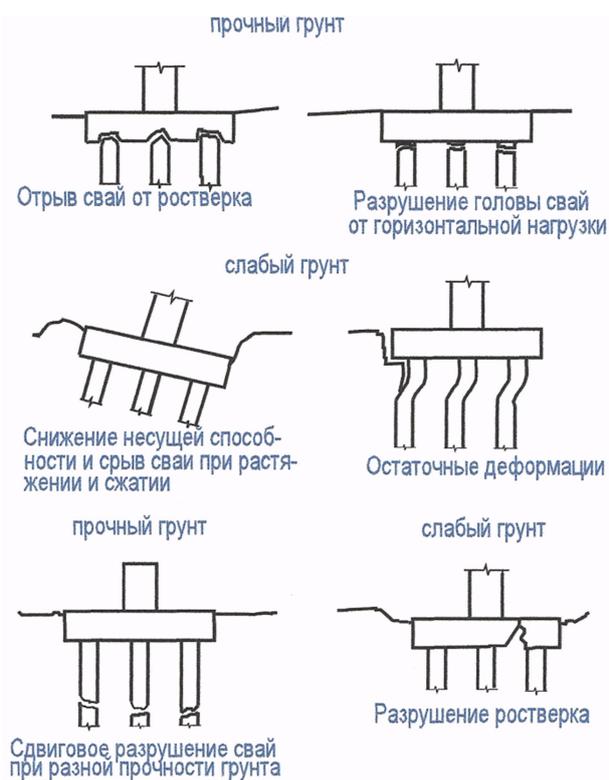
Различные виды сейсмических разрушений свайных фундаментов
